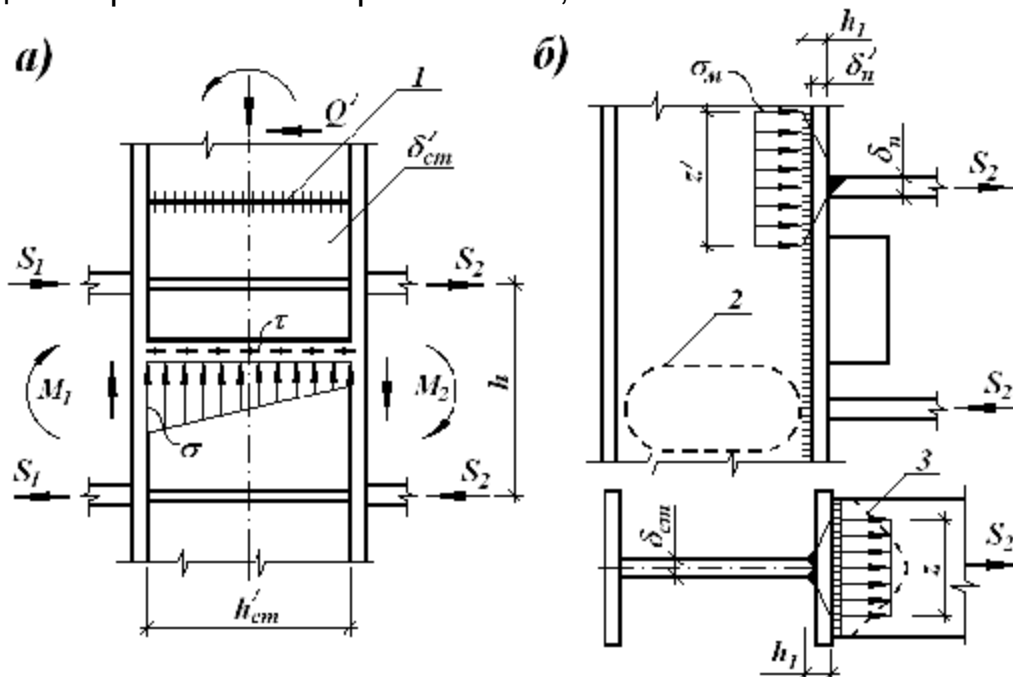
К расчету рамного узла. а – с поперечными ребрами жесткости; б – без ребер; 1 – стык в месте утолщения стенки; 2 – сжатая зона стенки; 3 – характер фактической эпюры напряжений в сварном шве.
